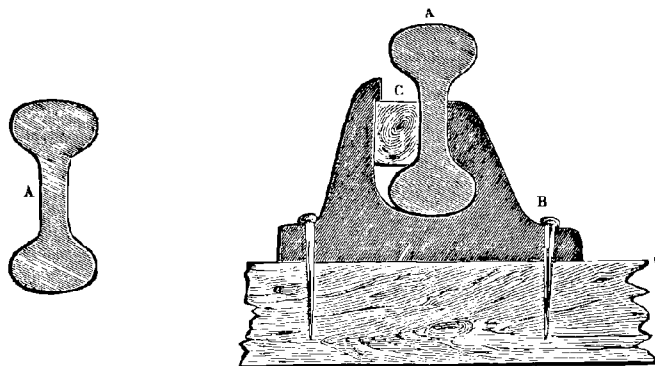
Coupe verticale d'une traverse et d'un rail à double champignon.
